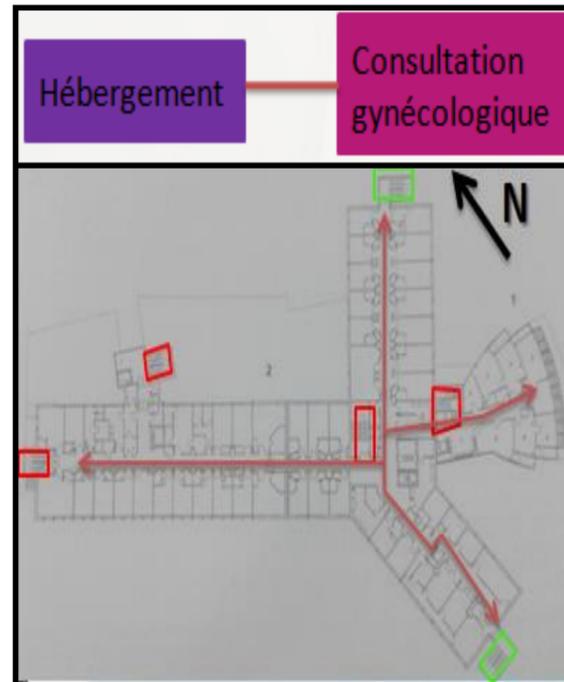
Plan du 2<sup>eme</sup> étage. Source : auteur
